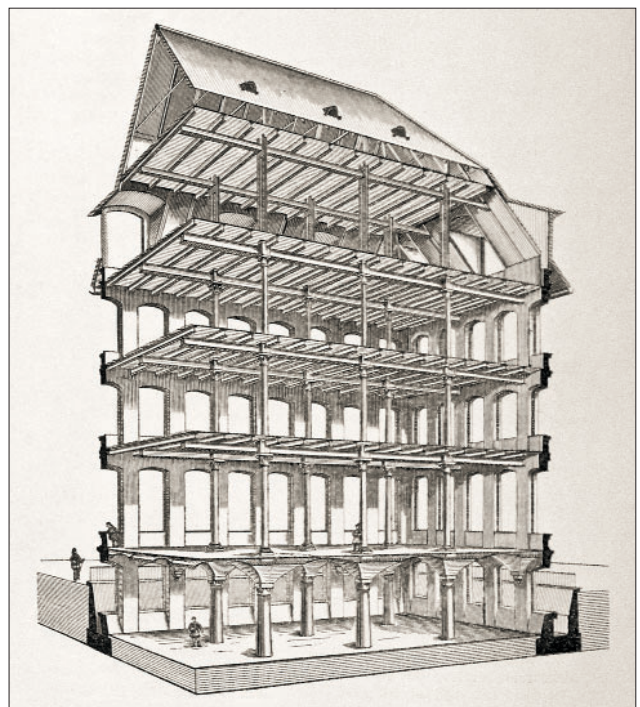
Lagerhaus mit „Monier-Decken“ [12]
